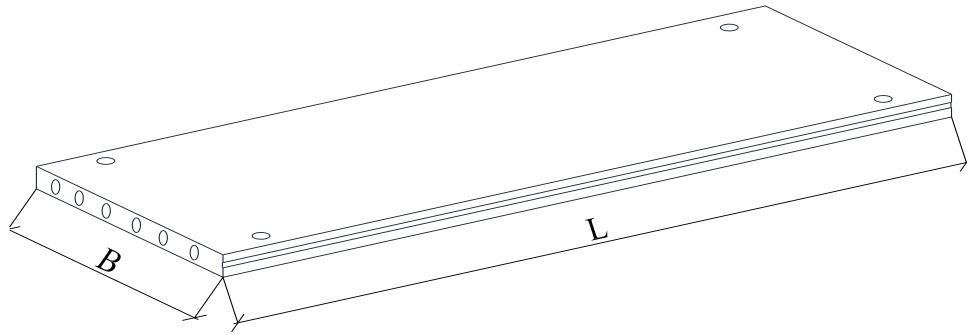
Конструктивна схема багатопустотної залізобетонної плити перекриття типу ПК
